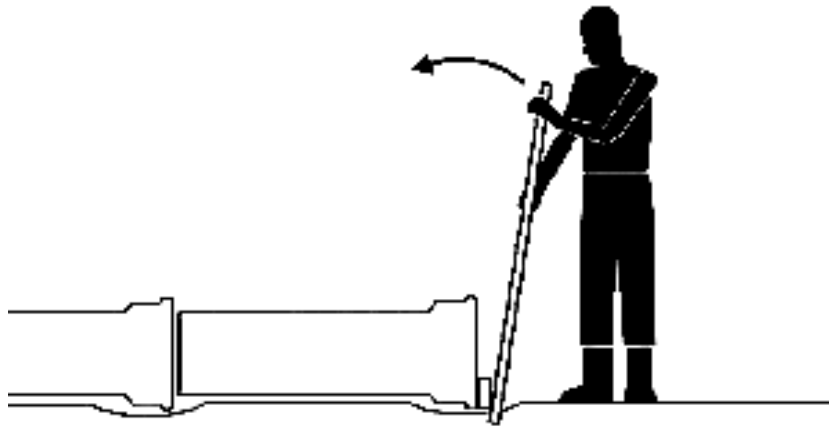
La palanca toma apoyo en el terreno. El canto del enchufe debe protegerse con una pieza de madera dura o barra de acero.
